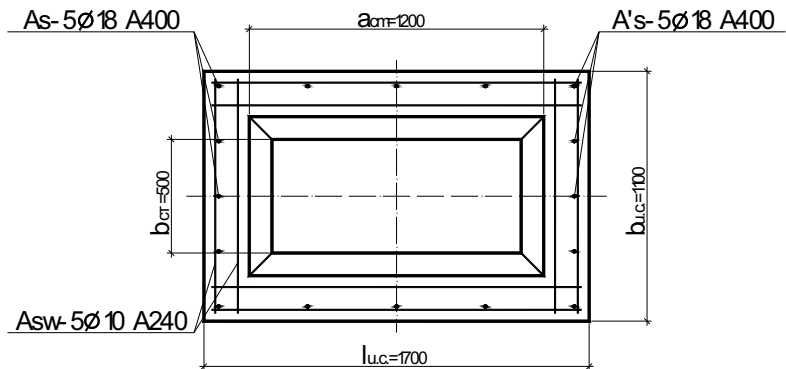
Схема армирования плитной (а) и стаканной(б) частей фундамента.
